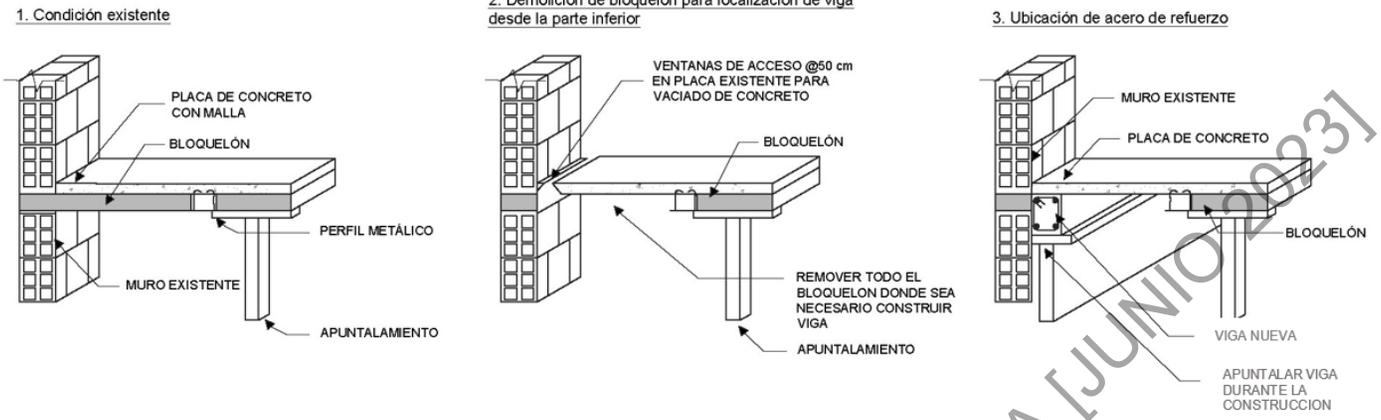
22 Construcción de nueva viga para dar rigidez al diafragma. Viga paralela a los perfiles metálicos.
